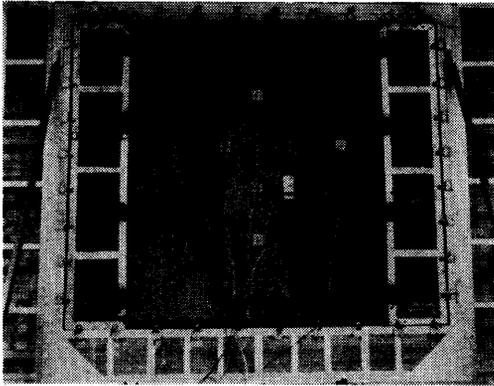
合板製B級仕切用防火扉試験体 (Specimen 21)
